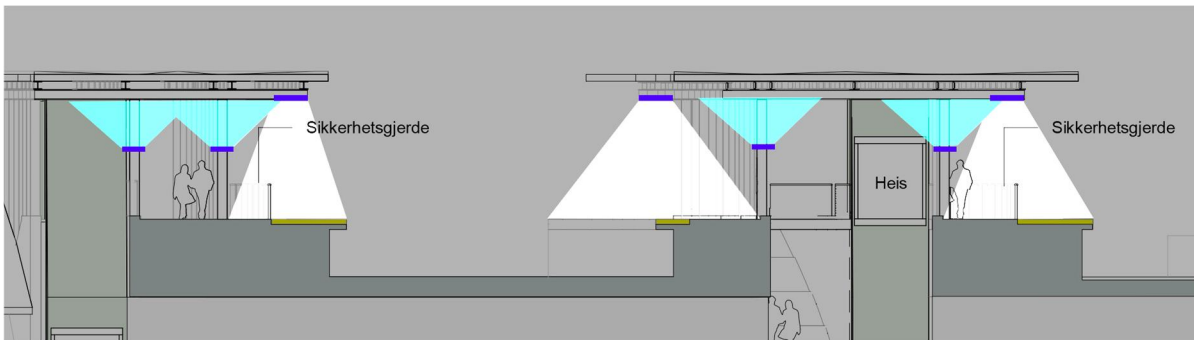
Prinsippsnitt slepelys langs betongvegger i kulvert
